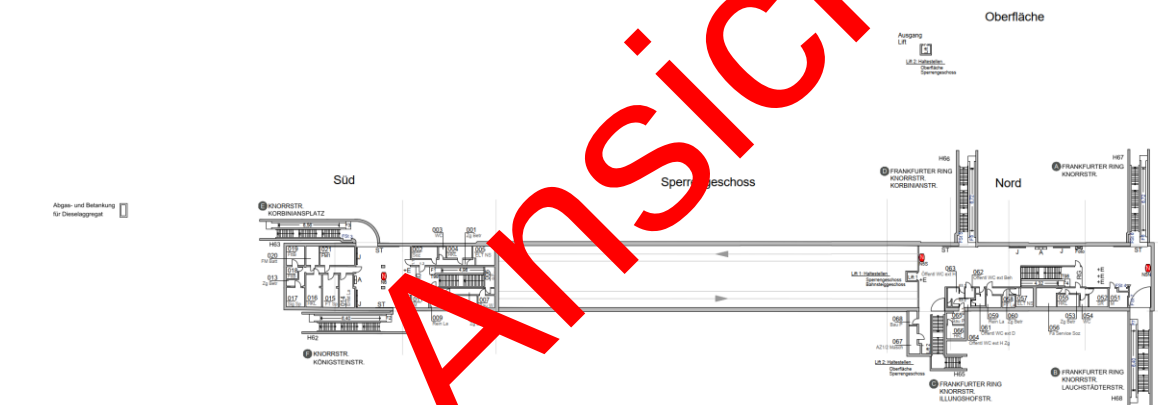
Grundriss Sperrengeschoss FF
